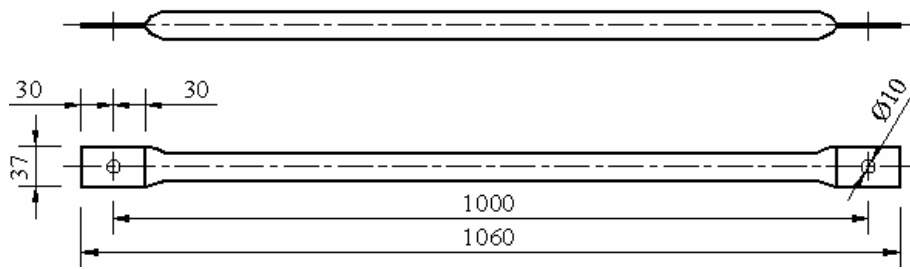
Banzo - detalhe do amassamento e furação (mm)
